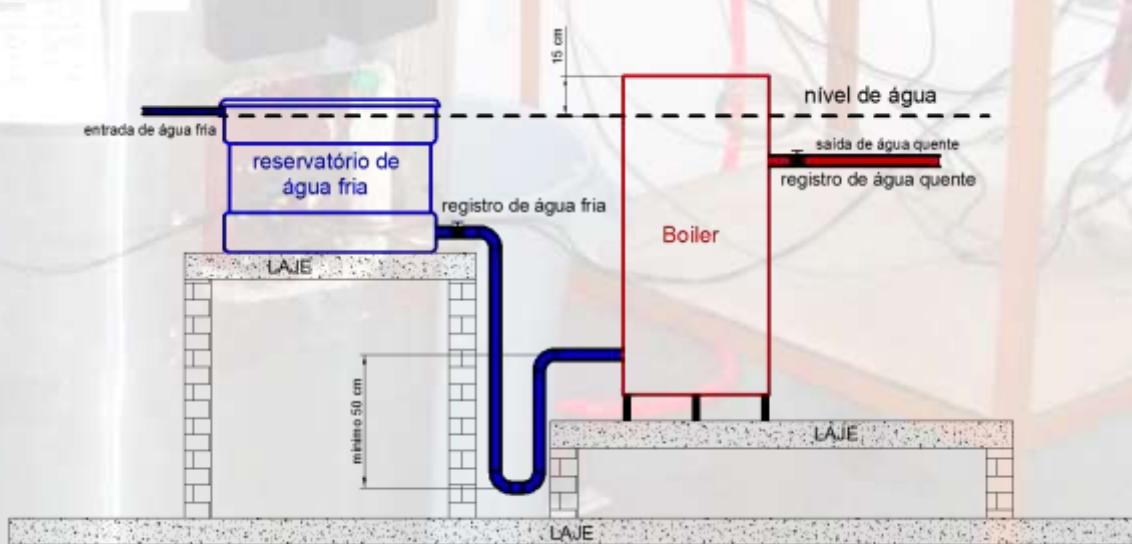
Boiler instalado em nível com caixa d'água exclusiva.
